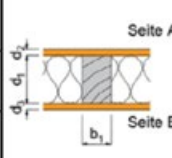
Horizontalschnitt Konstruktionsvariante 3
